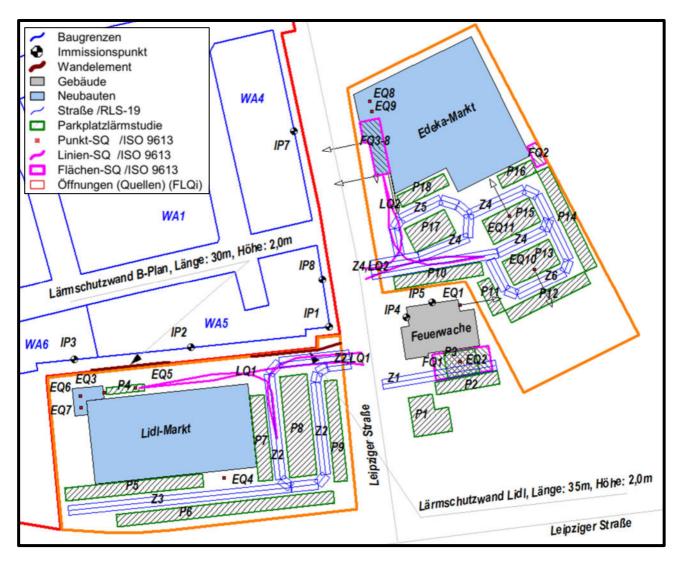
Lageplan Schallquellen, nächstgelegene Immissionsorte und geplante Lärmschutzbauwerke der "Gesamtlast"
